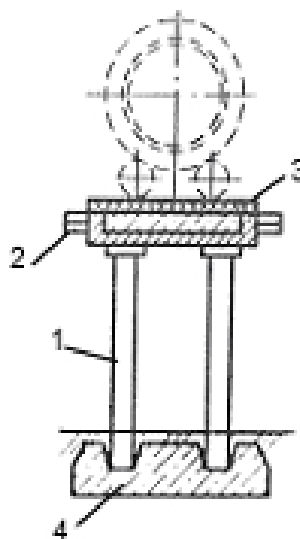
Схема рамного фундамента: 1 – стойки; 2 – ригель; 3 – верхняя плита рамы; 4 – опорная плита
